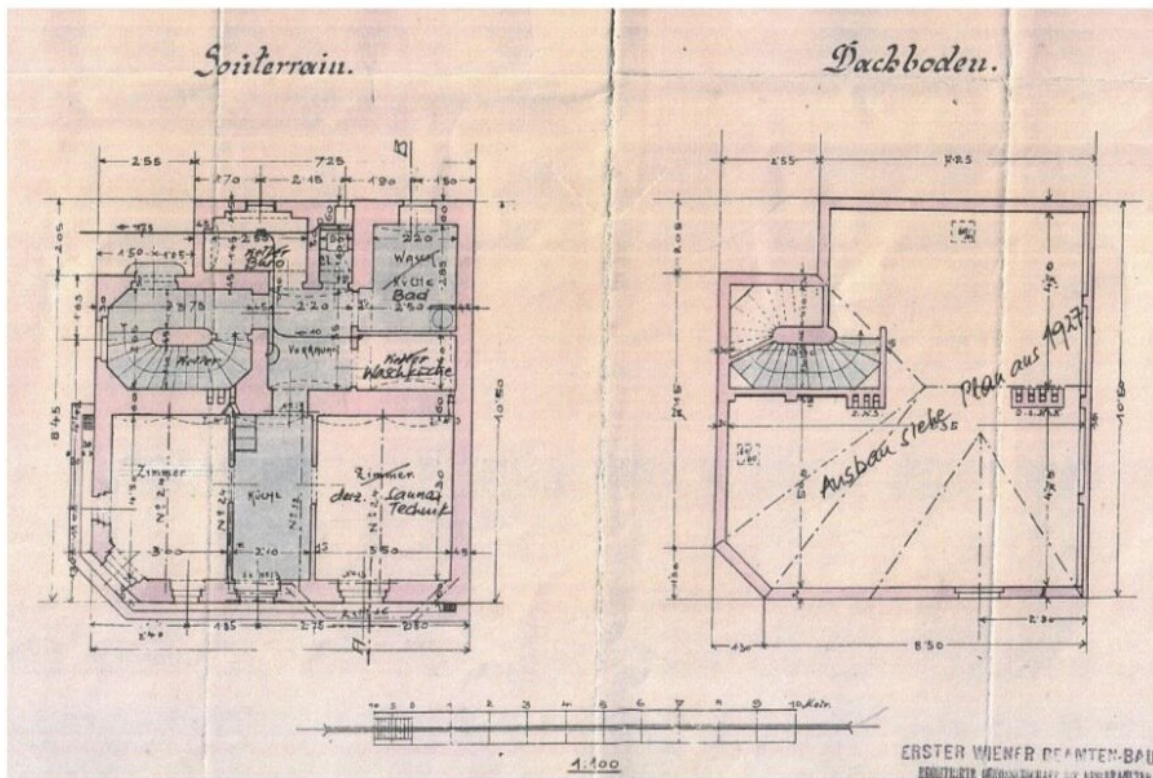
Erbauungsplan 1904, Souterrain und Dachboden, ergänzt mit derzeitiger Raumnutzung
